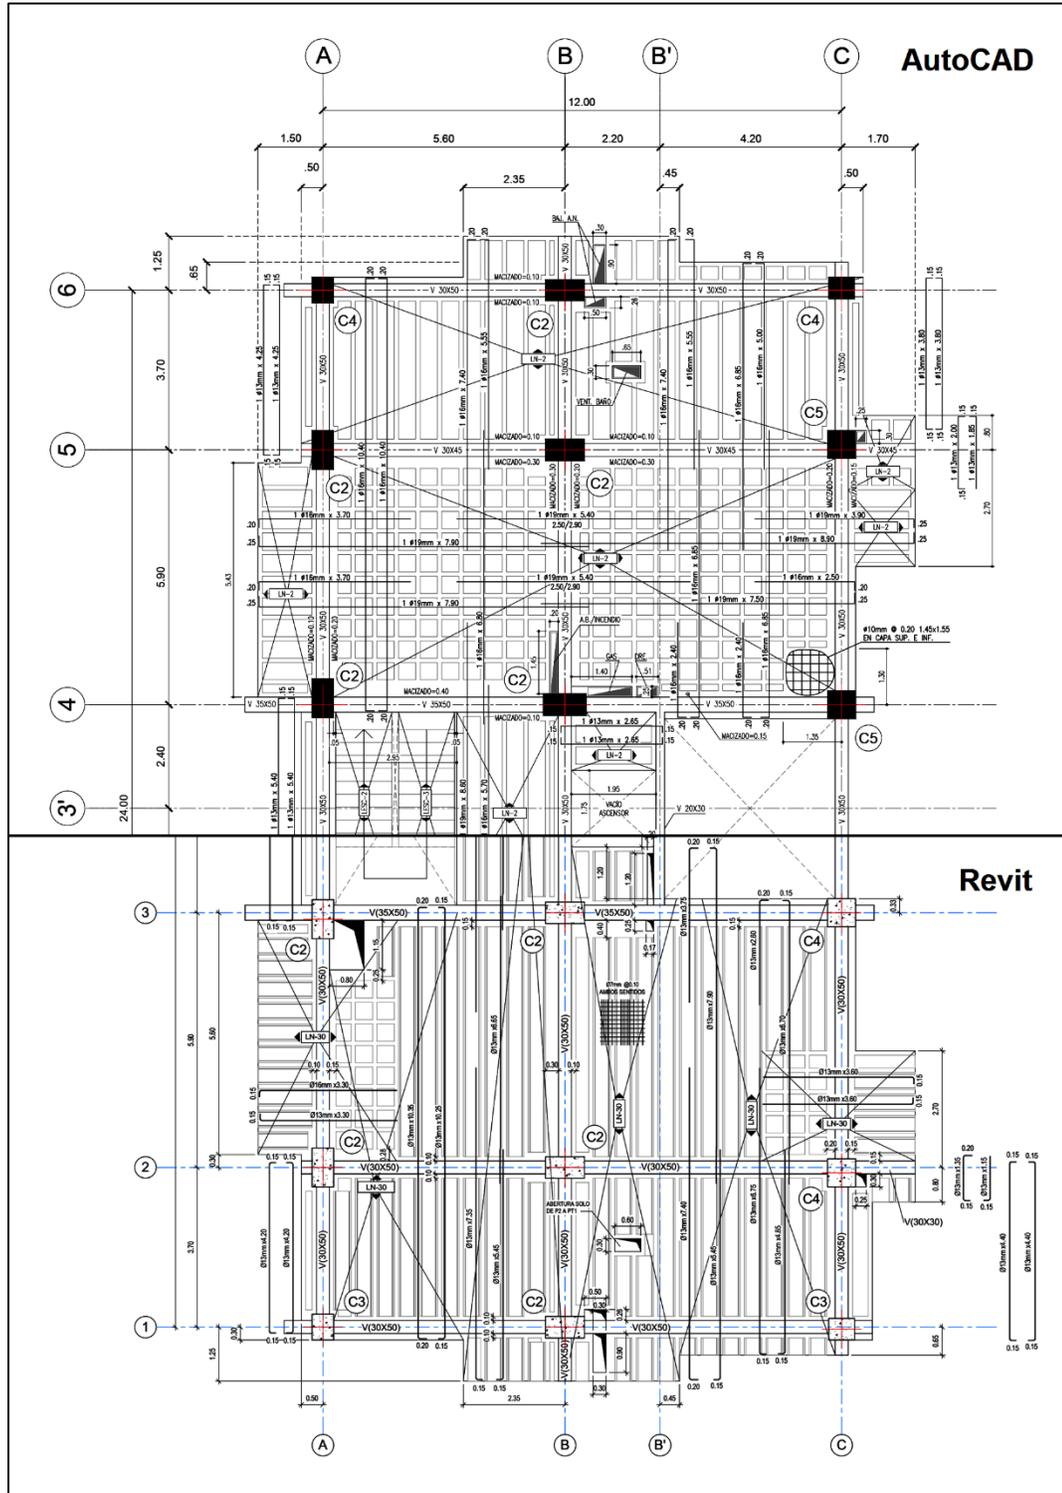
Detalle de armado de acero en losa de P.A. en CAD y BIM
